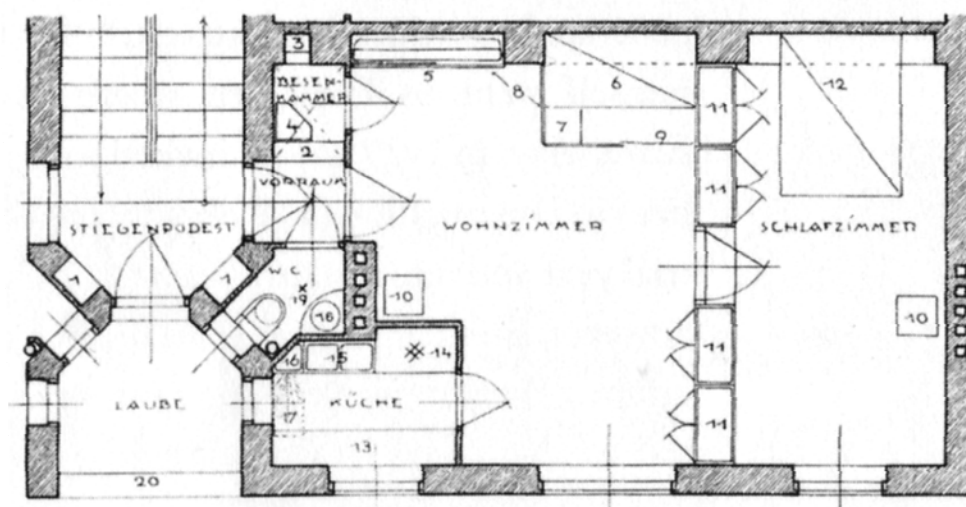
, Grundriss Wohnung Rauchfangkehrergasse Wien 15 mit Einbaumöbeln 1926, Architekt Anton Brenner, Quelle: Eve Blau: The Architecture of Red Vienna 1919 - 1934, S 187
